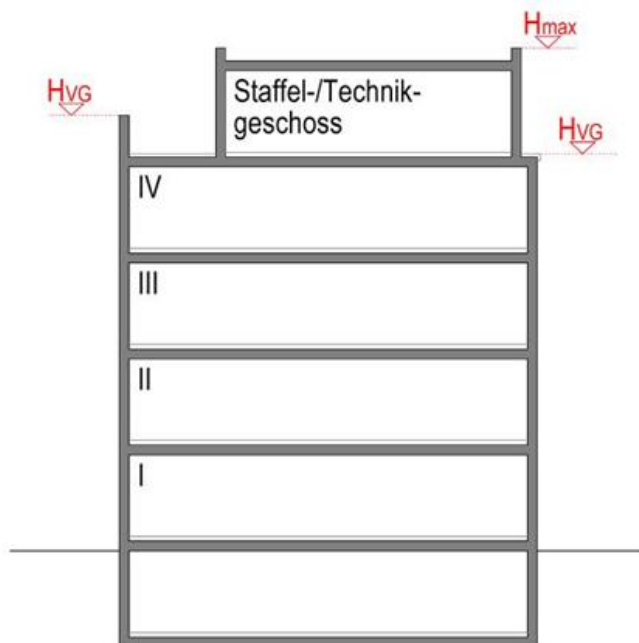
Schnitt Gebäude mit Staffelgeschoss
